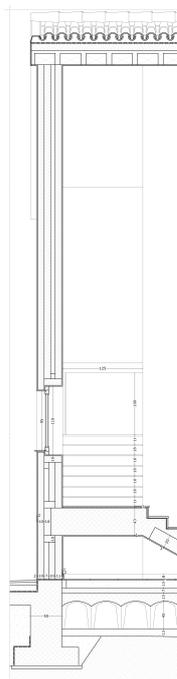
Striscia di facciata verticale (Tav. n°17 scala 1:20)
